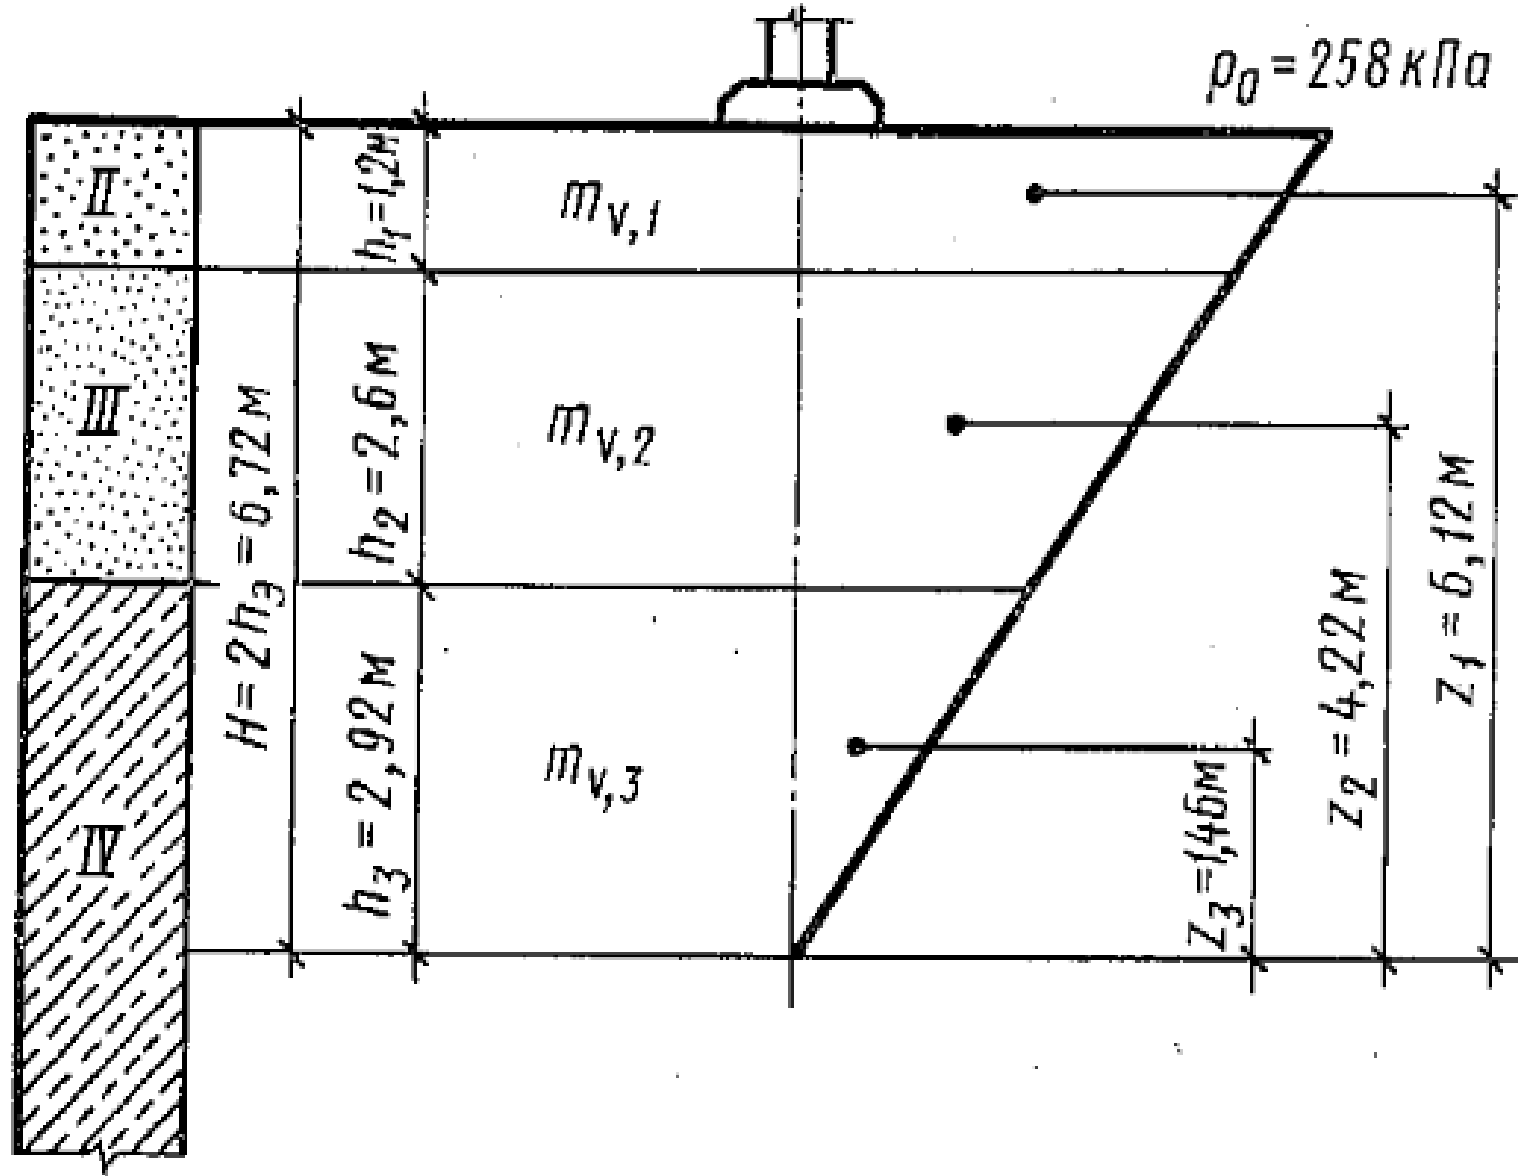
Схема к расчету осадки фундамента методом эквивалентного слоя (пример 2.4)
